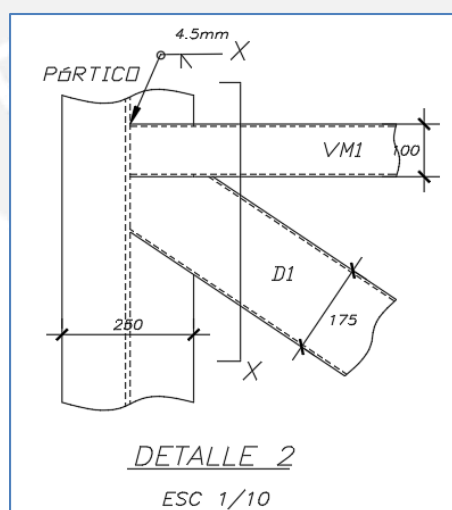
DETALLE DE UNIÓN SOLDADA ENTRE VM1, D1 Y PÓRTICO DE ACERO
